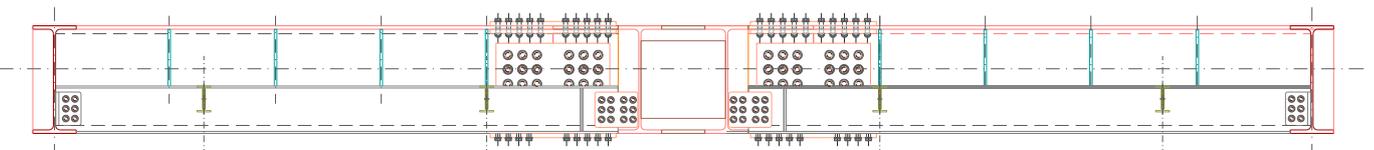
Sezione trasversale dell'impalcato di copertura
